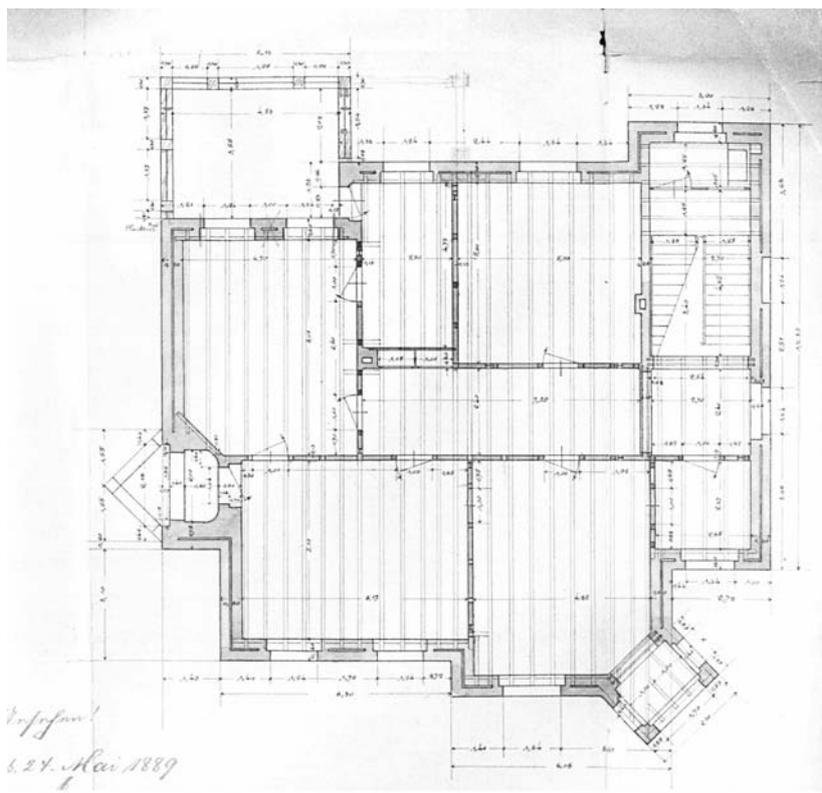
H. Plange, Grundriss Obergeschoss, 1889
